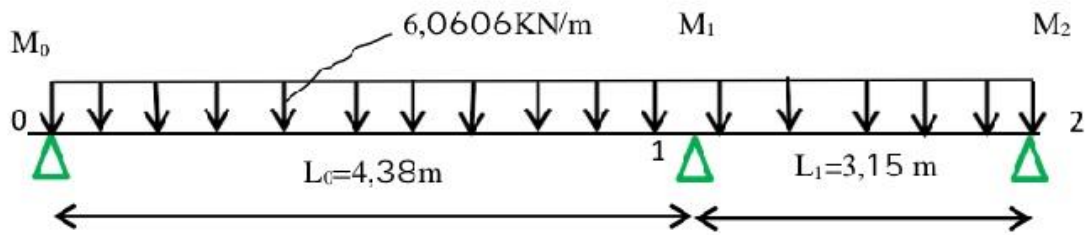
2: Schémas statique la poutrelle de type01(ELU)
